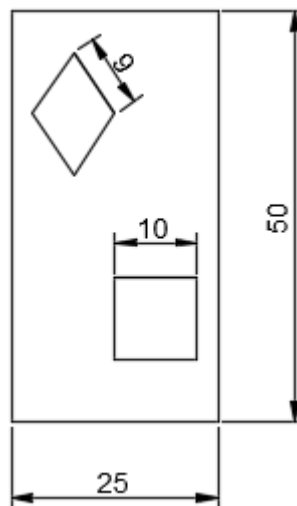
Secção do exemplo 1 (dimensões em cm).
